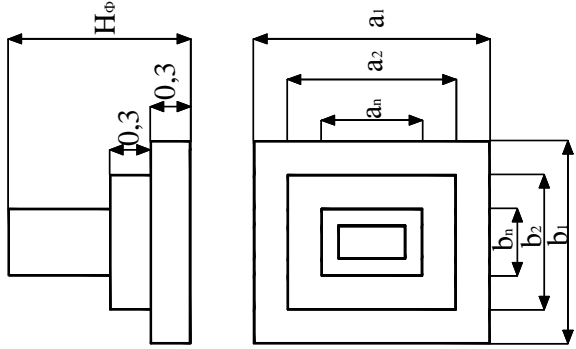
Фундаменты сборные под колонны (по Веселову В.А.)
